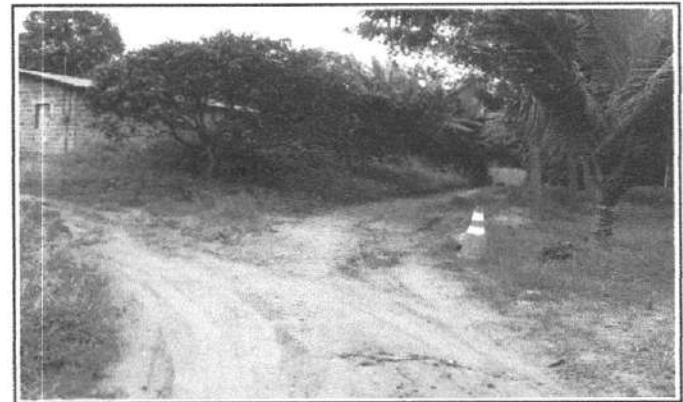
Trecho: Rua S.D.O. 02 - Vila Santo Expedito
